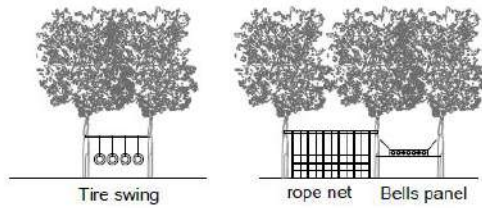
Boceto de elementos distribuidos en el colegio. Vista en planta y alzado entre los arboles
